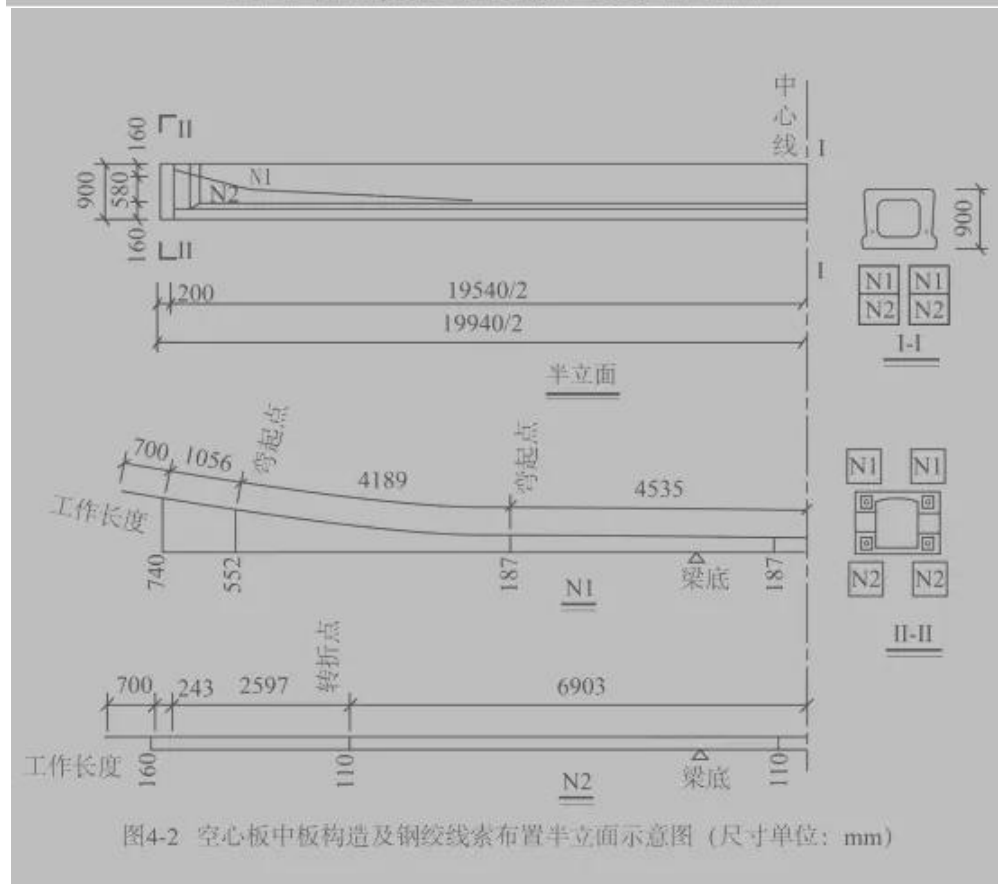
空心板中板构造及钢绞线索布置半立面示意图（尺寸单位：mm）
